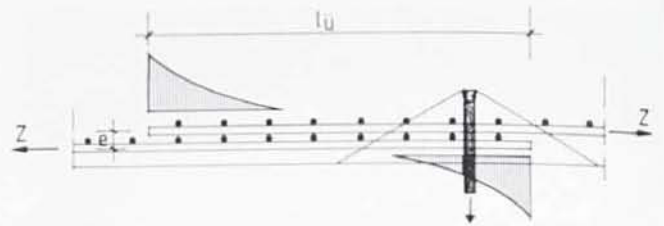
Dübel im Bereich eines Übergreifungsstoßes geschweißter Betonstahlmatten
